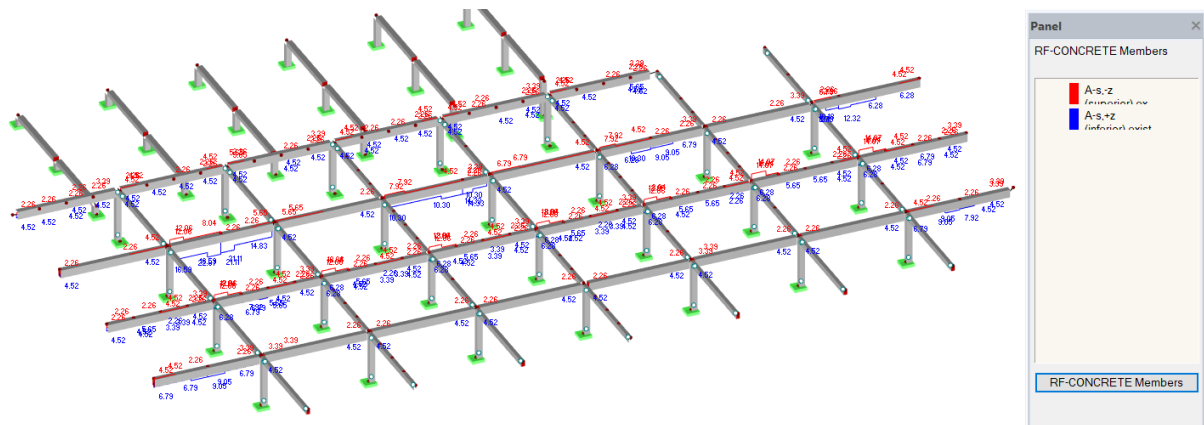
Cantidad de armadura existente en las vigas principales del sótano.
